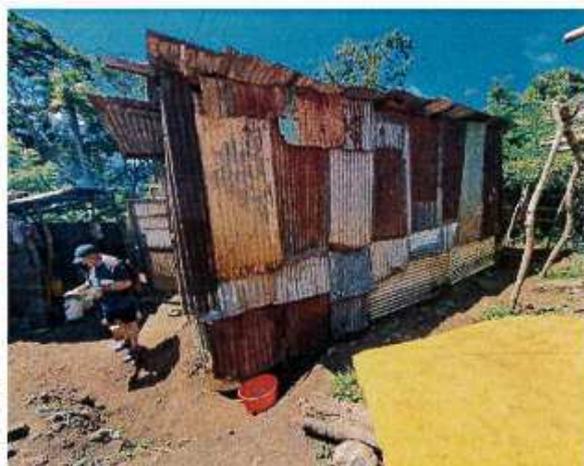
assemblage de morceaux de tôle ondulée rouillée, absence d'ouvertures donnant sur l'extérieur
